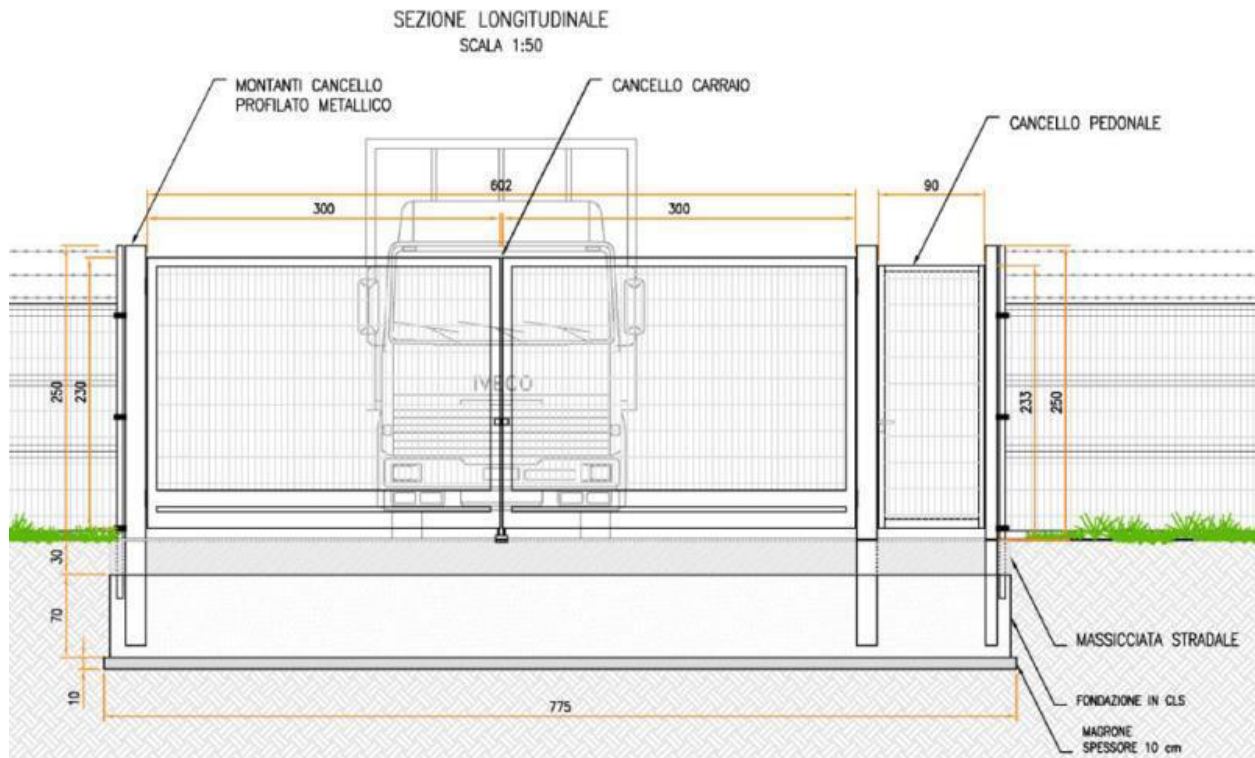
Sezione longitudinale accesso carraio e pedonale
